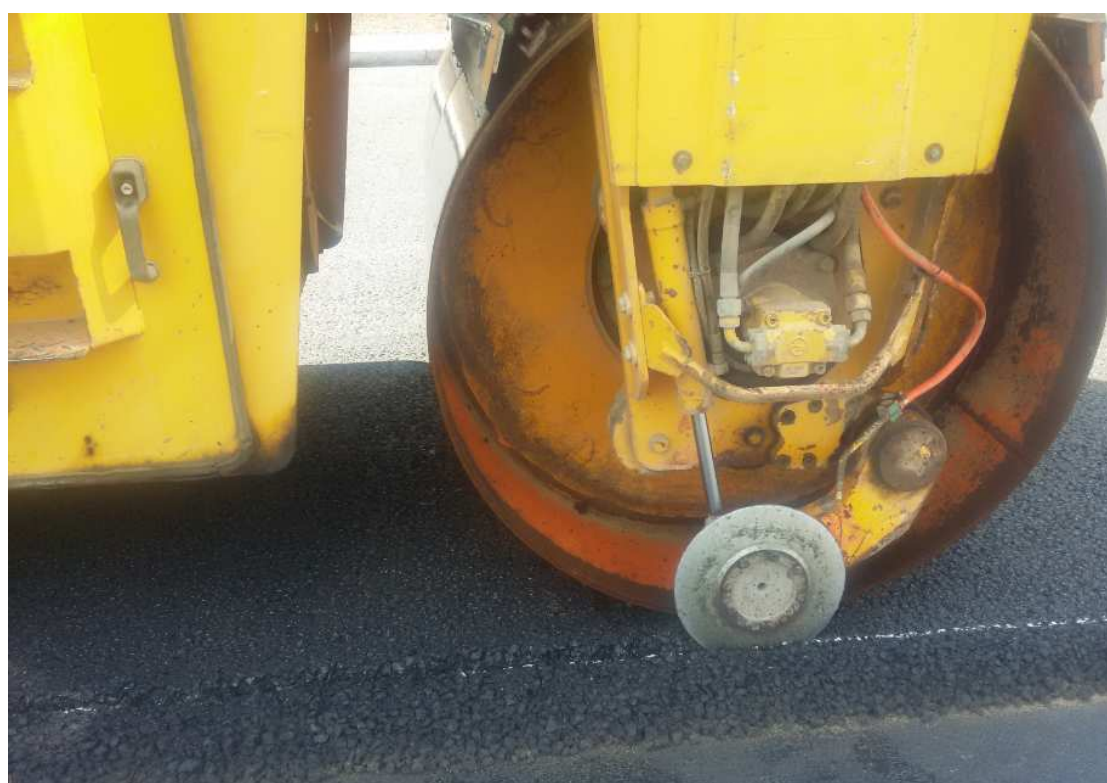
Продольная прорезка ранее уложенного и уплотнённого слоя асфальтобетонного покрытия
